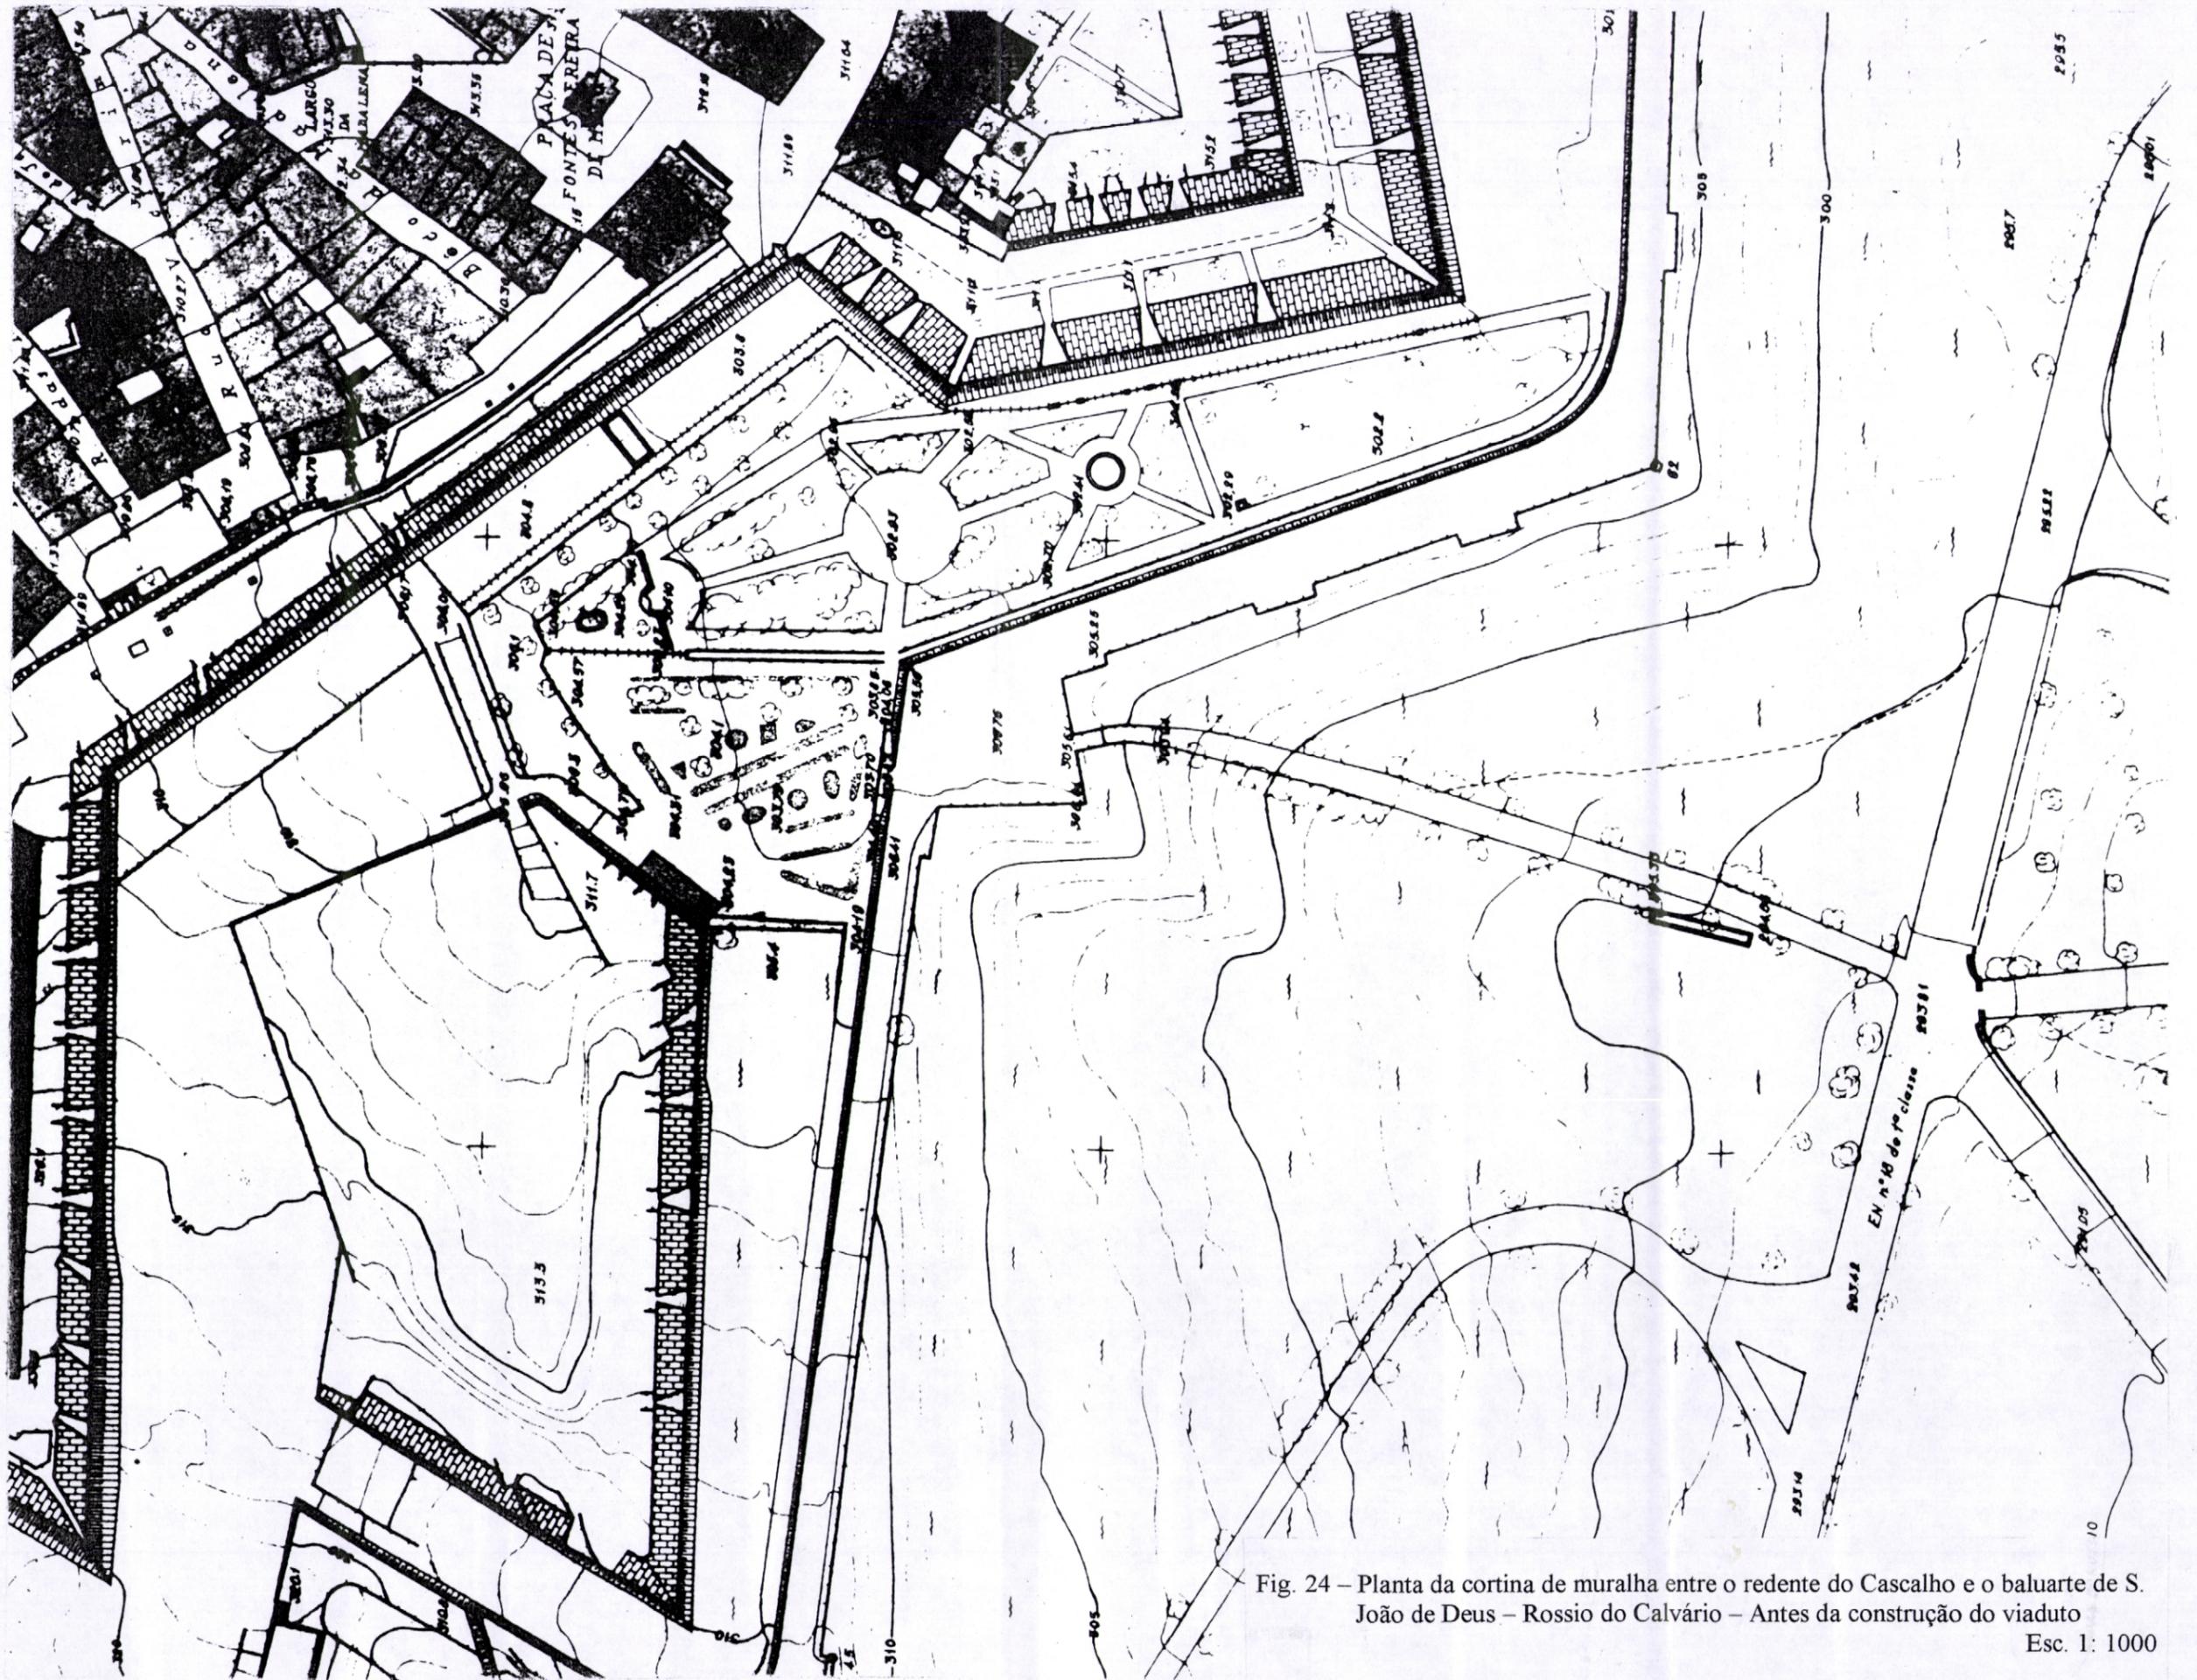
Planta da cortina de muralha entre o redente do Cascalho e o baluarte de S. João de Deus – Rossio do Calvário – Antes da construção do viaduto
